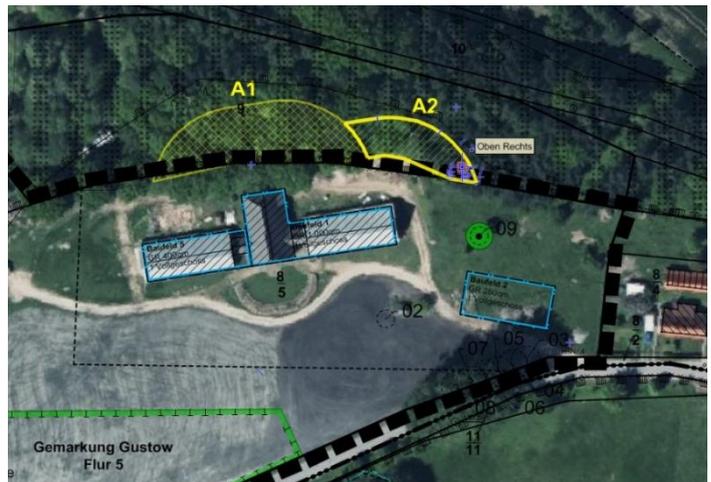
Waldflächen mit Unterschreitung Waldabstand
